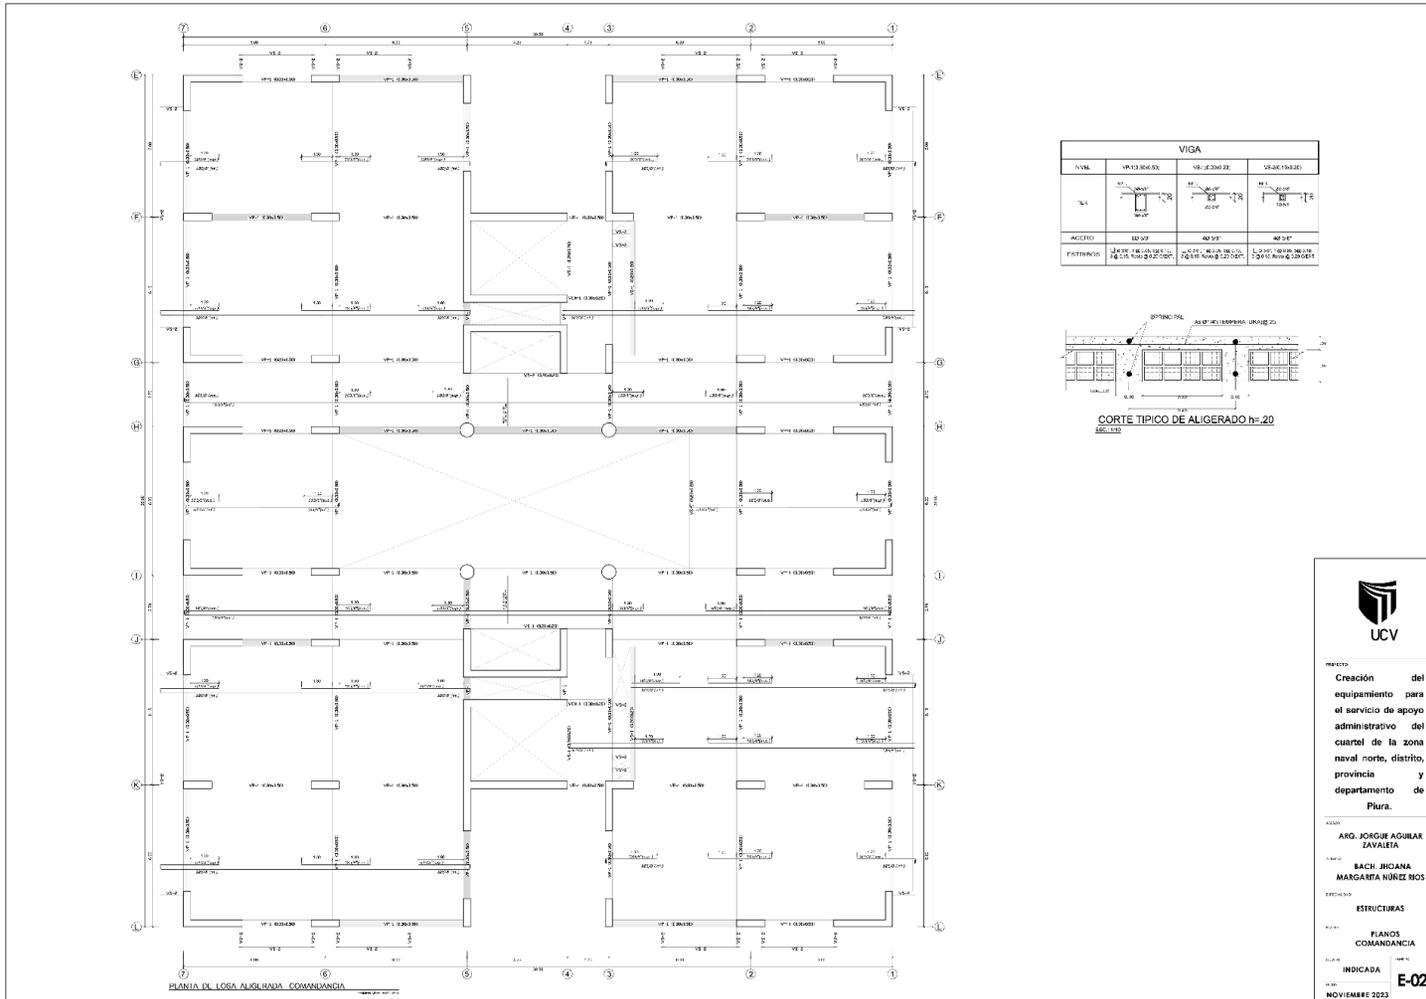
Plano de losas y vigas – Bloque comandancia Segundo nivel
